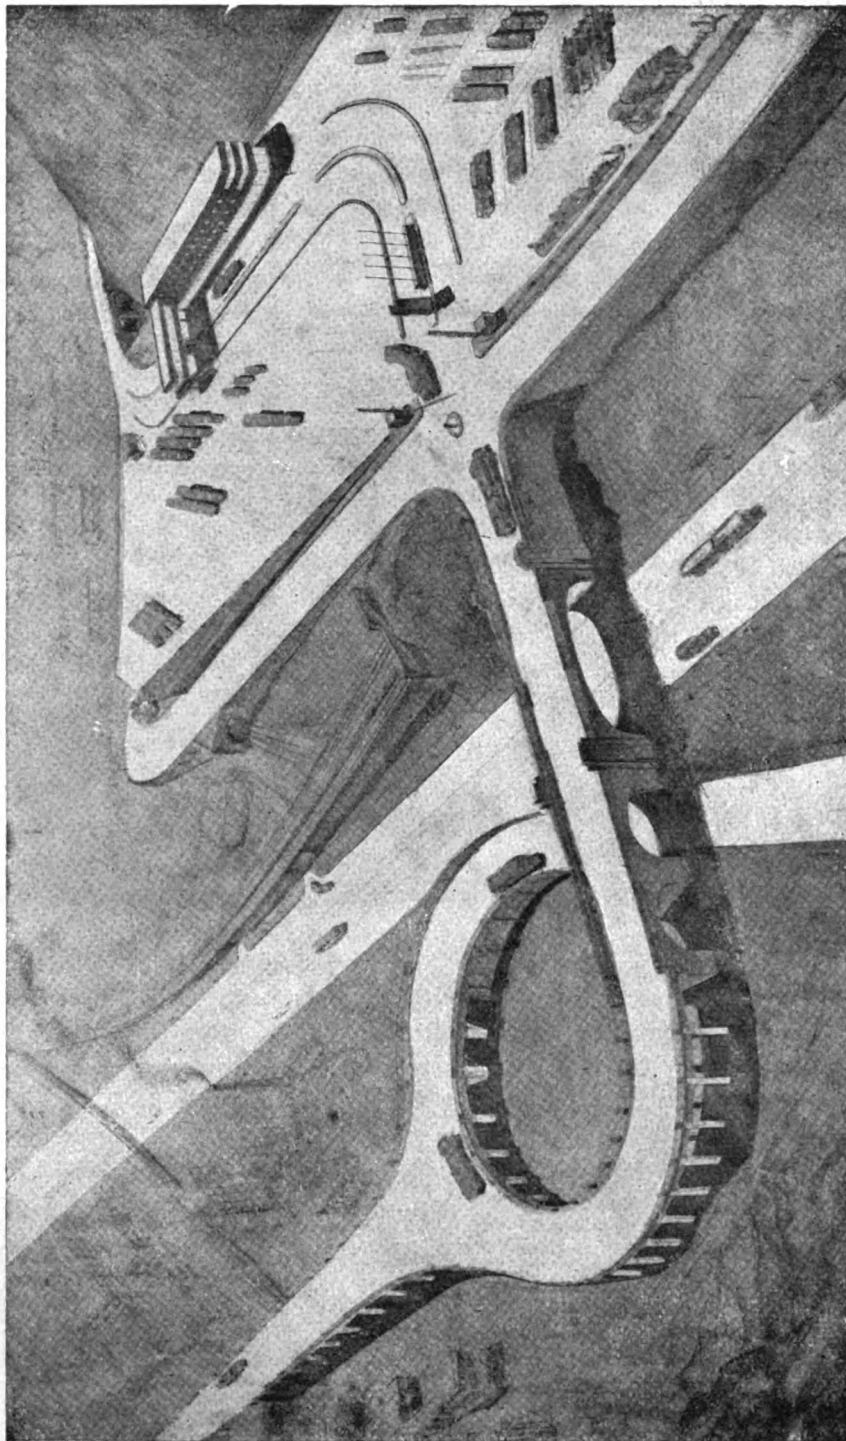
Il piazzale di Genova e le rampe di accesso.
